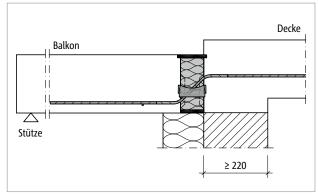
Schöck Isokorb $^{\circ}$ T Typ QL: Einbausituation mit kleinem Höhenversprung
